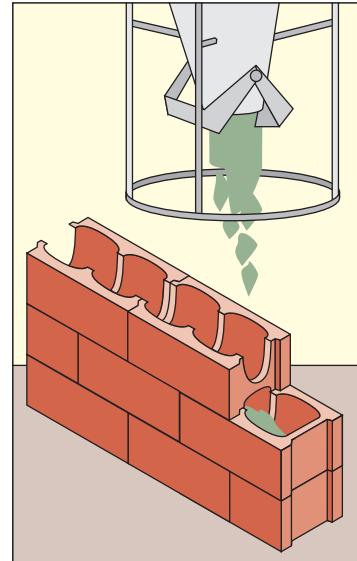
Mauerwerk mit Vermörtelung durch Gießmörtel
